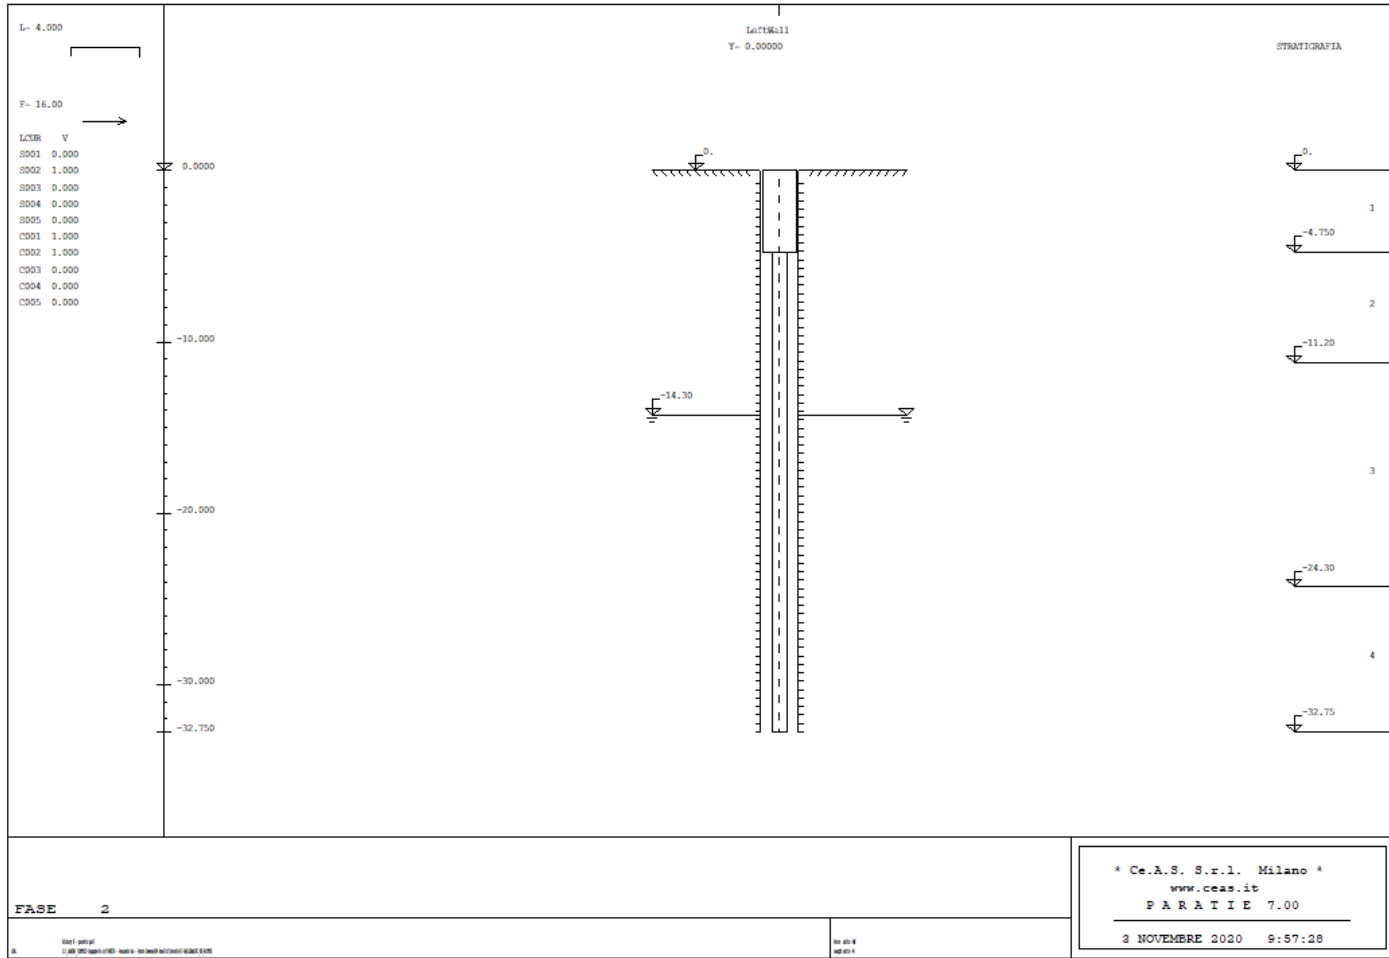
Fase 2 – Realizzazione paratia e muro corpo spalla
